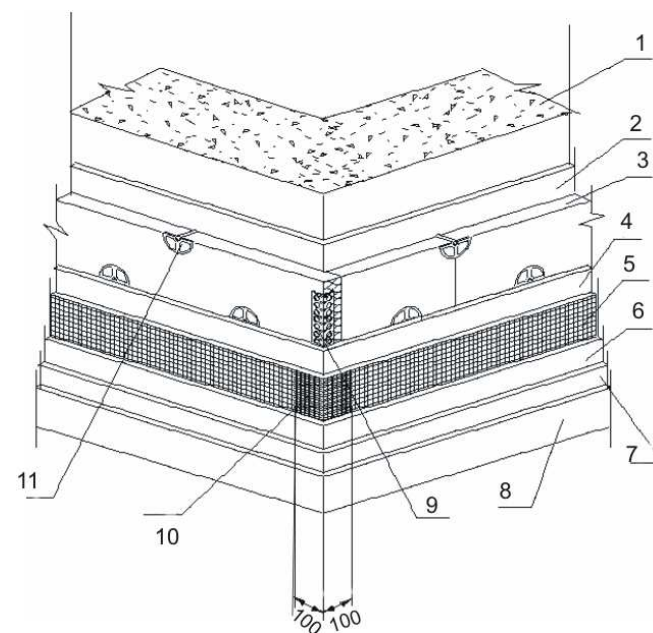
Схема соединения двух полотен стеклосетки на углу здания.
